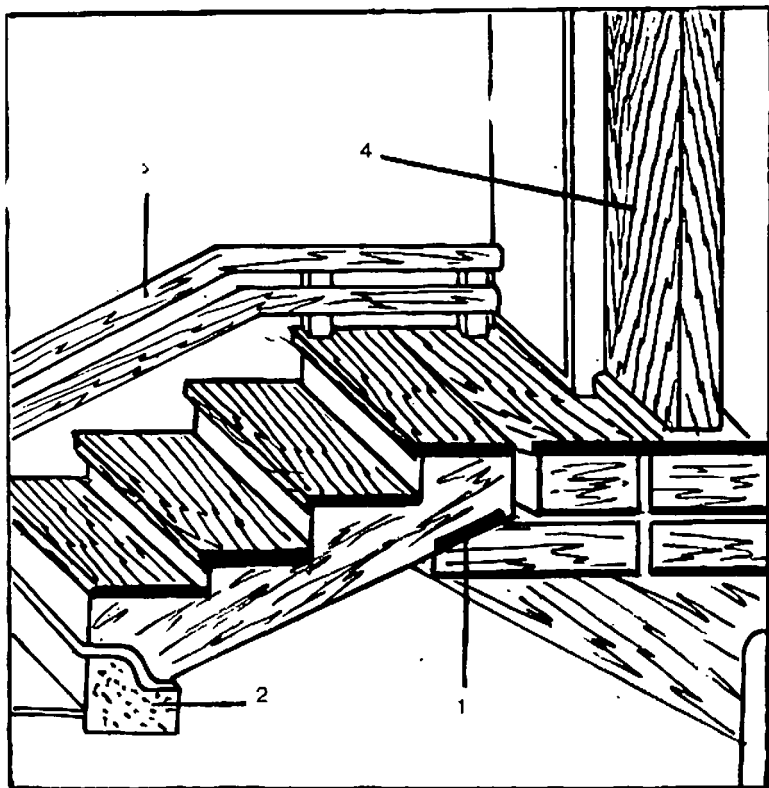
Лестница для крыльца с внутренней опорной доской и наружной железобетонной опорой:
